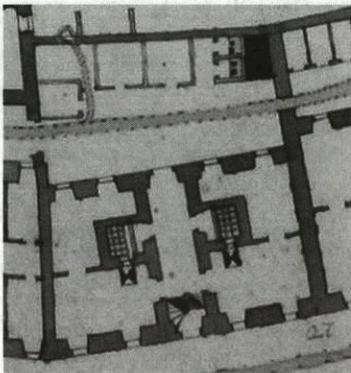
Obermünsterstraße 6, vor 1766 (Münchner Plan).
